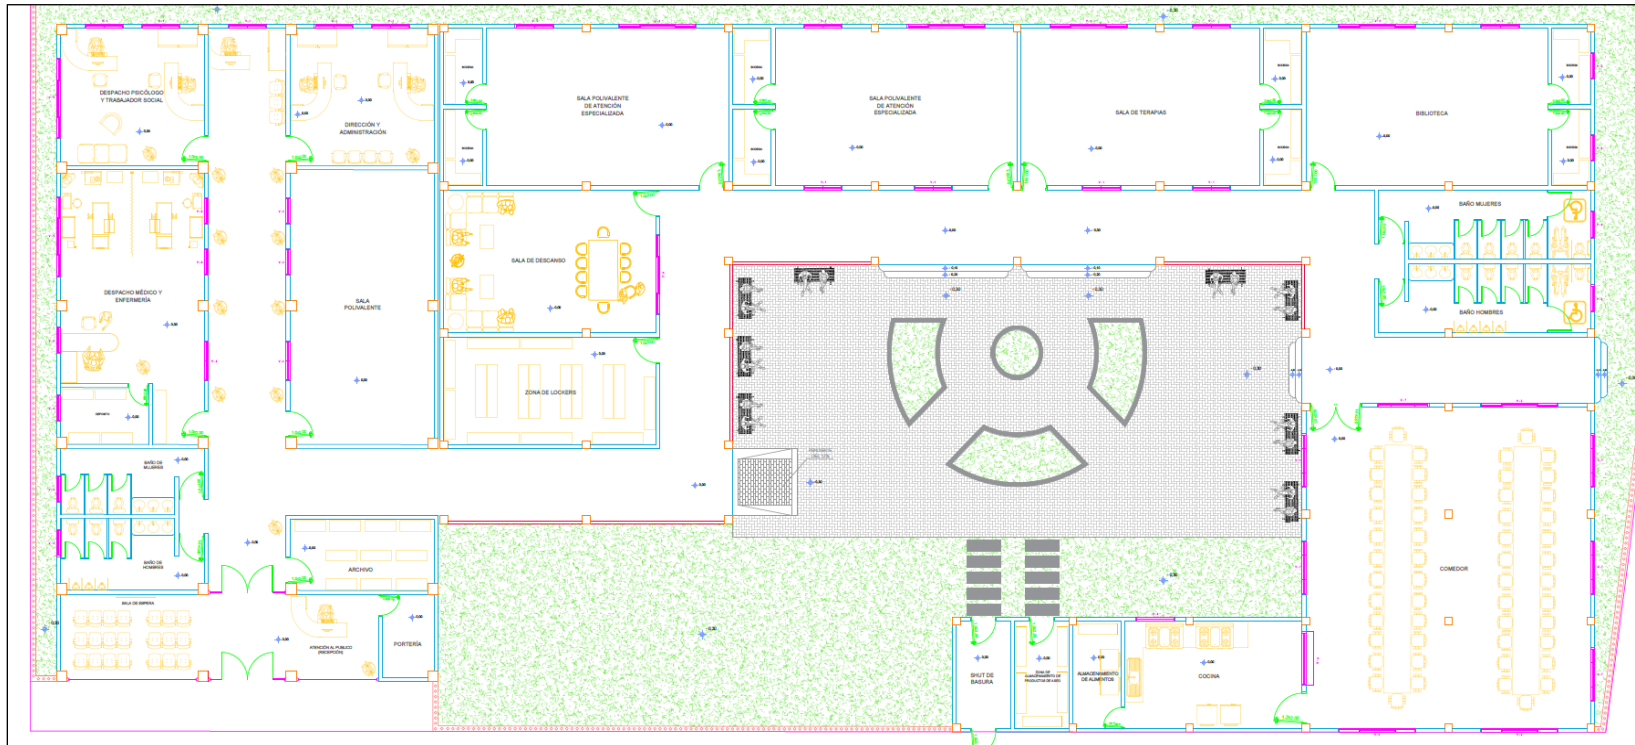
Diseño arquitectónico de las tres estructuras que conforman el Centro Vida.
